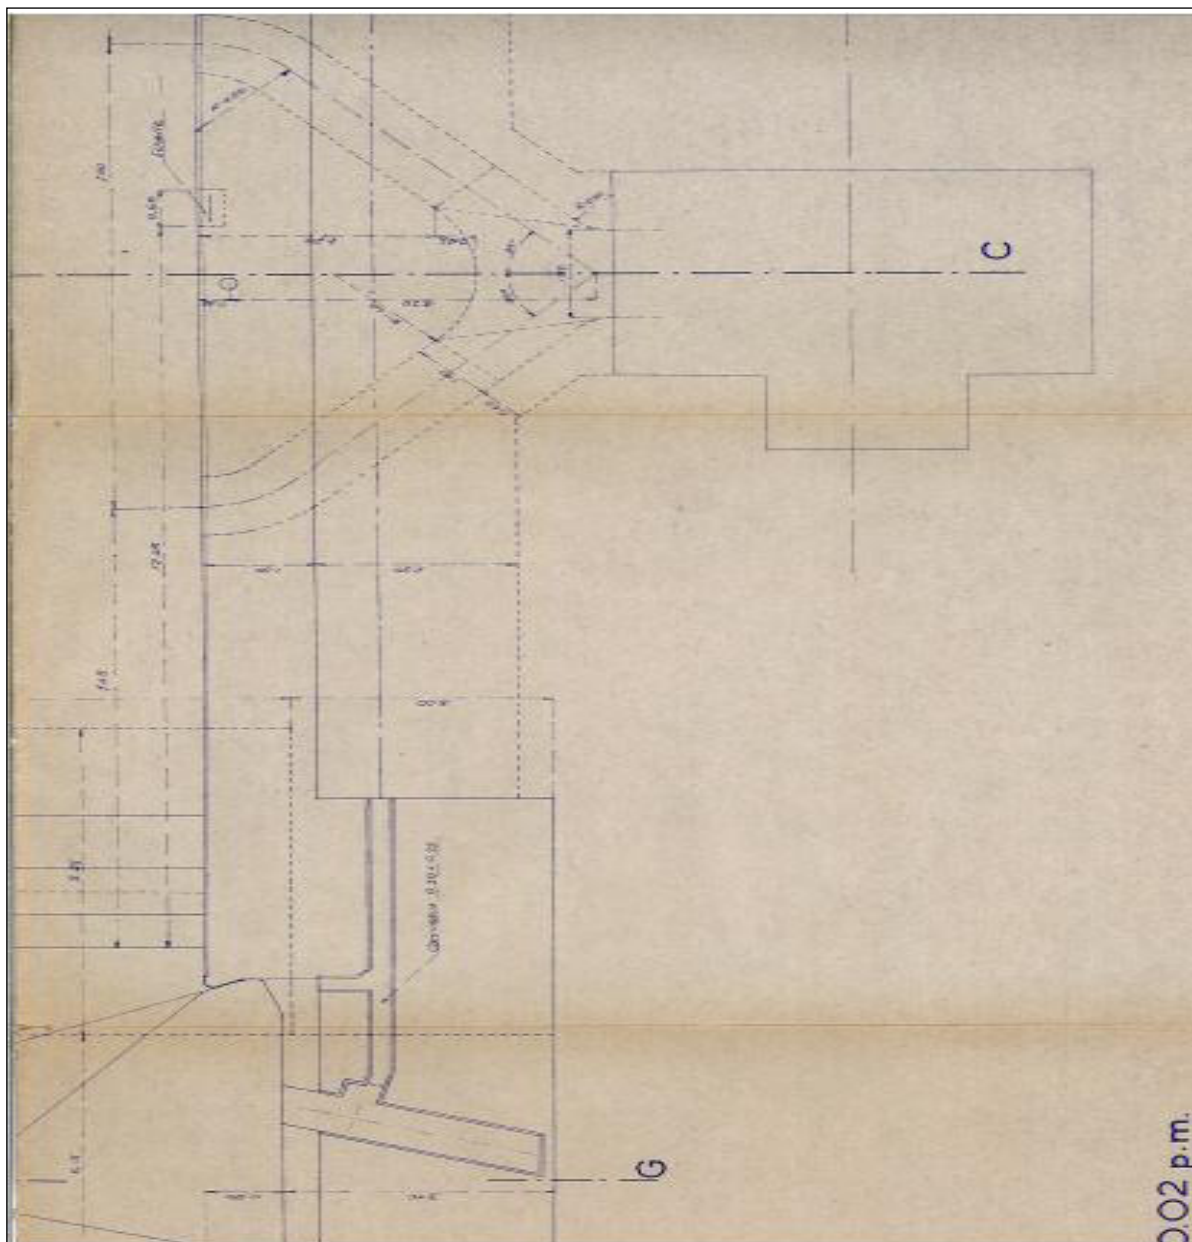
Cotation des conduits d'un vannage en vue en plan. Source : VNF.
